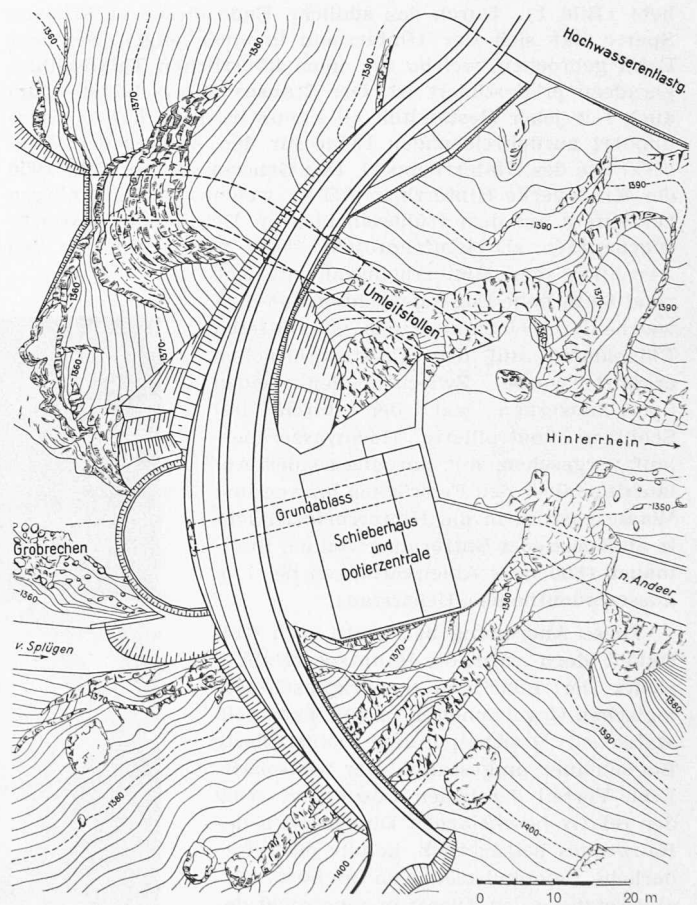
Stau-mauer Sufers, Lageplan 1:1000
